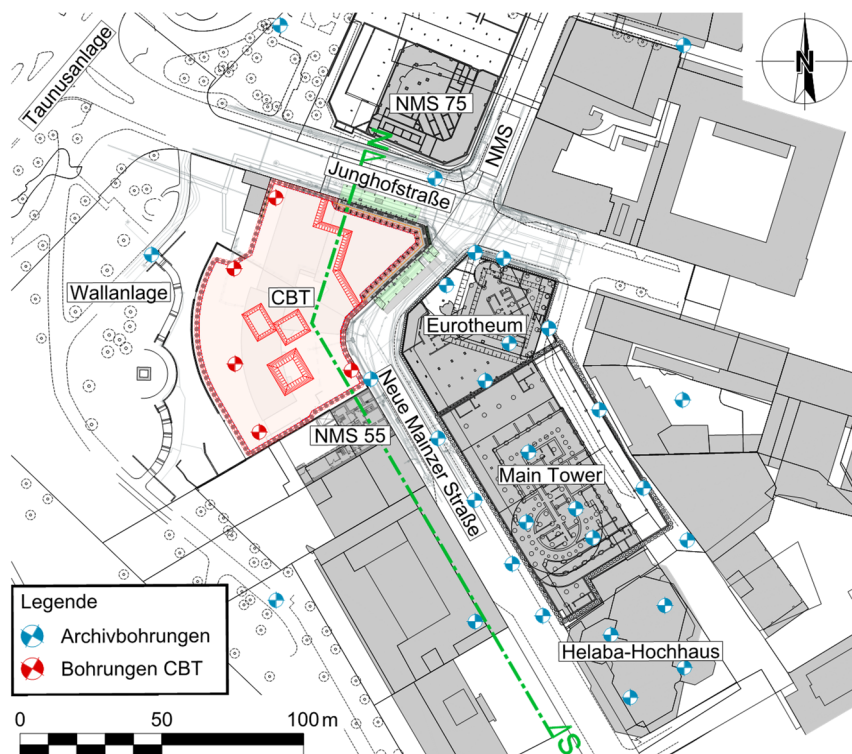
Lageplan mit Bohransatzpunkten und Schnittführung
